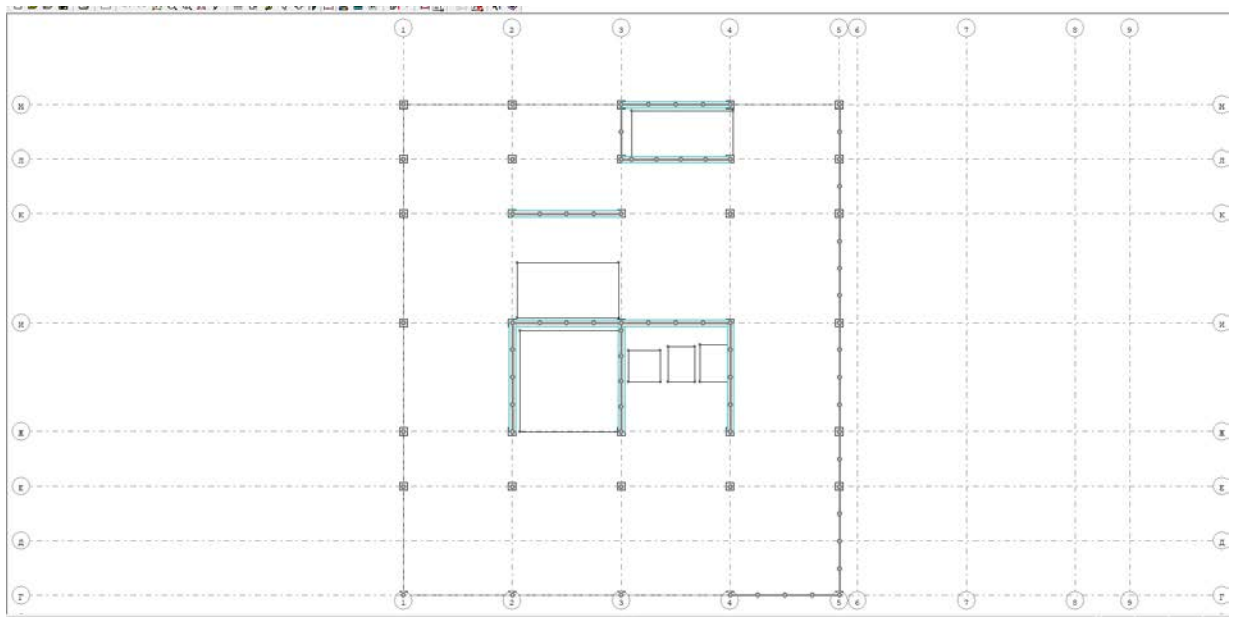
Креслення плити ПМ 1 опалубочне на від 0.000.
